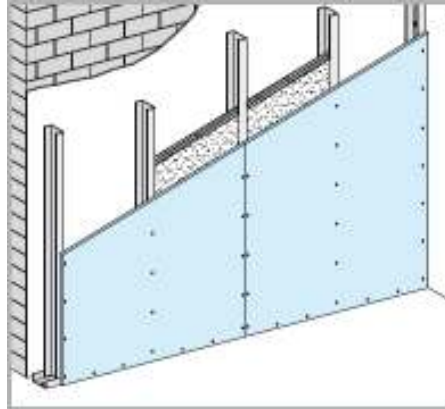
Trasdosado interior de fachada con placa de yeso laminado, estructura metálica y lana mineral.
